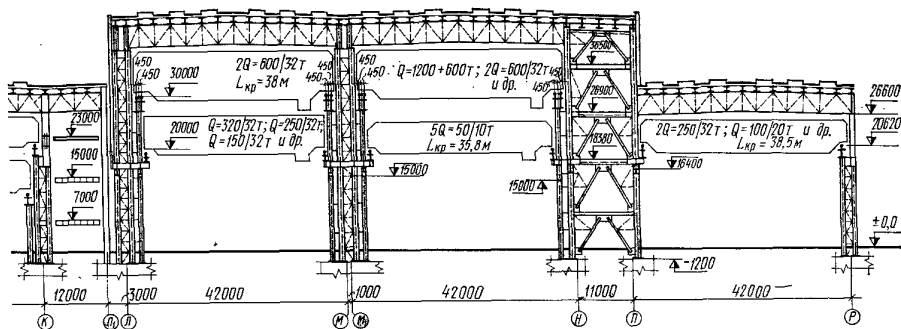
Поперечный разрез части каркаса здания Атоммаша со сверхмощными мостовыми кранами
